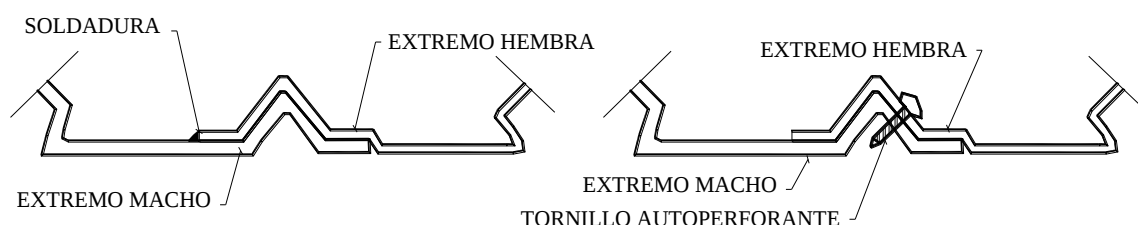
Tipos de sujeción entre láminas colaborantes: con soldadura y tornillos.
